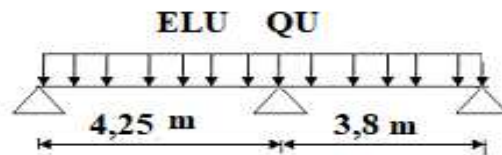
Schéma statique de la poutrelle à 3 travées
